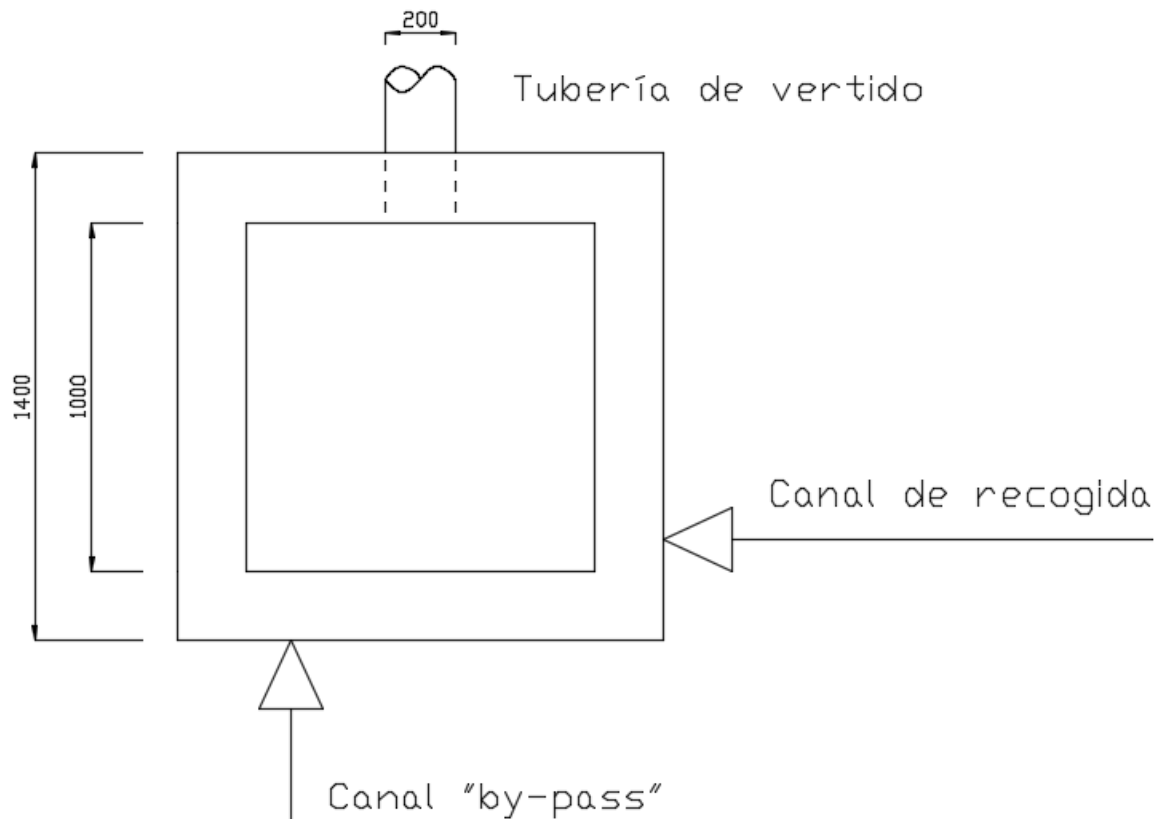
Arqueta de salida vista en planta (Cotas mm)
